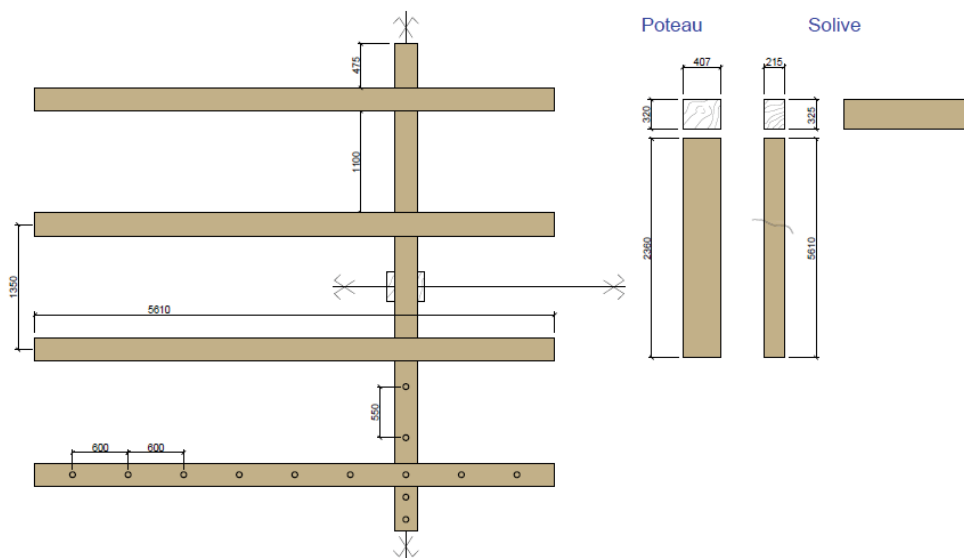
Détail des solives, entretoises et poteau de l'essai 3 (Poteau/poutres LC)
